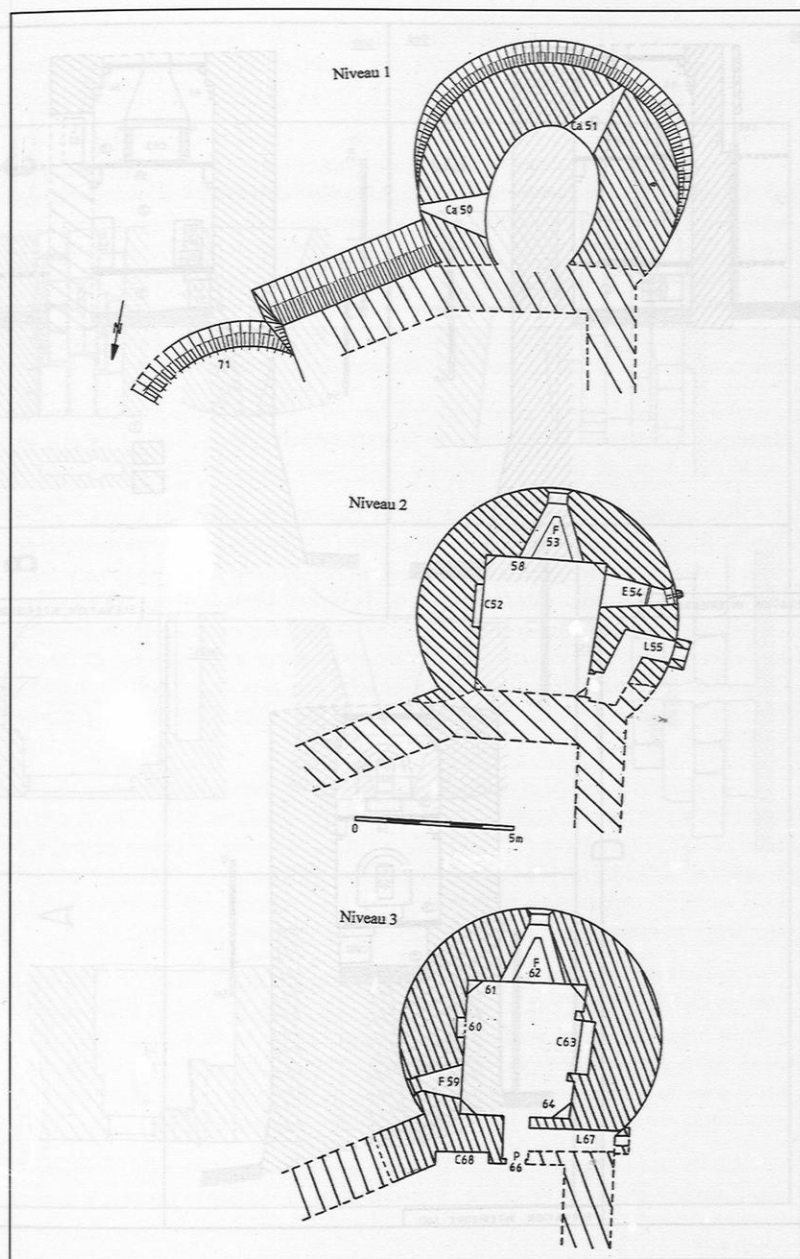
Tour ronde. Plans par niveaux. Pour la légende voir plan n° 3.
